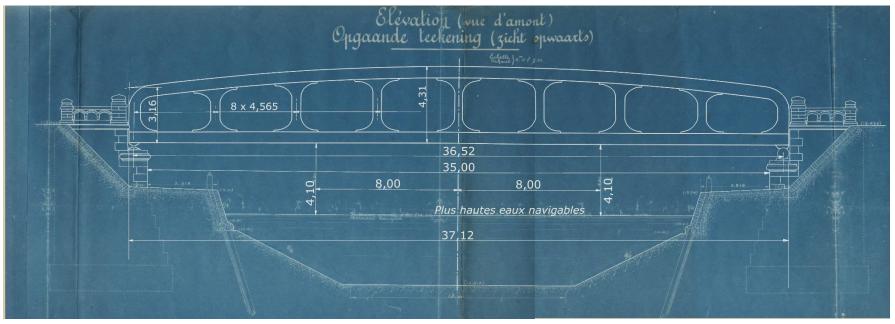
Vue en élévation du pont d'Houplines (extrait des plans originaux – archives de la commune de Ploegsteert)
